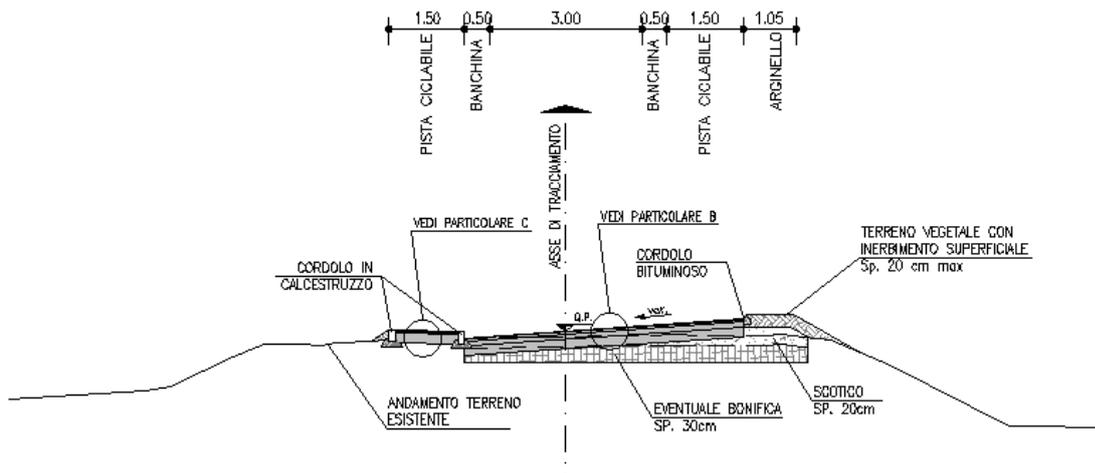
Sezione tipo di progetto via Piave, tratto in rilevato.
